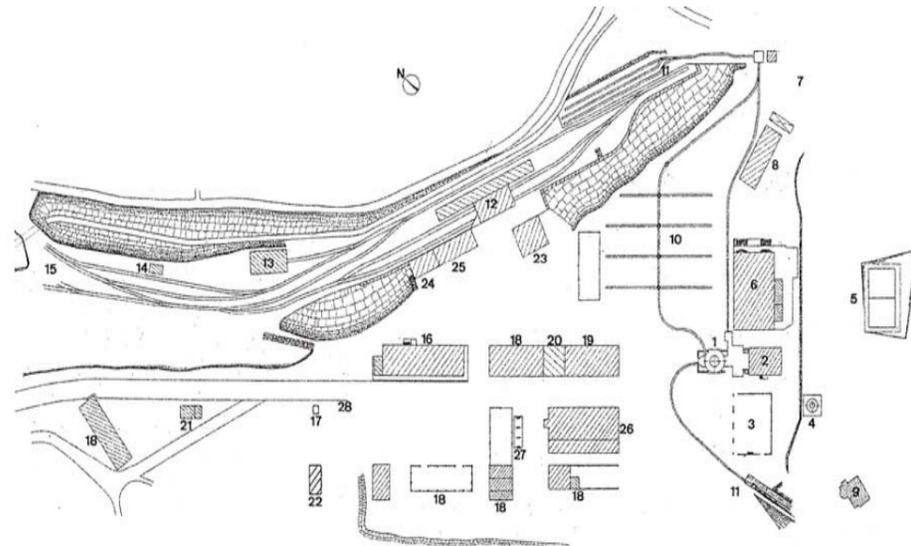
Plano de las instalaciones de superficie, 1925. (*Services généraux. Installations générales Lieres. Plan d'ensemble des installations de surface*). Lieres, 15-12-1925, firmado G., escala 1:200 en el original. Archivo Solvay Lieres. Calco de Minerva Alvarez. LEYENDA: 1 Pozo nº1. 2 Sala de la máquina de extracción. 3 Generador, antes sala de calderas. 4 Chimenea. 5 Depósitos de agua. 6 Central eléctrica. 7 Zona del polvorín. 8 Cuadras. 9 Ventilador. 10 Parque de maderas. 11 Plano inclinado del grupo Fraternidad (ángulo inferior derecho) y plano inclinado al lavadero (id. superior derecho). 12 Lavadero, selección y carga de carbones. 13 Cochera de la locomotora. 14 Caseta de la báscula. 15 Tendido al apartadero Rianes-Lieres. 16 Oficinas. 17 Retretes obreros. 18 Naves de almacenes. 19 Taller. 20 Carpintería. 21 Cochera y almacén de gasoil. 22 Garaje del camión. 23 Laboratorio. 24 Comedor. 25 Escuela de aprendices. 26 Casa de aseo. 27 Aparcamiento de bicicletas. 28 Avenida de acceso a la plaza de la mina.
